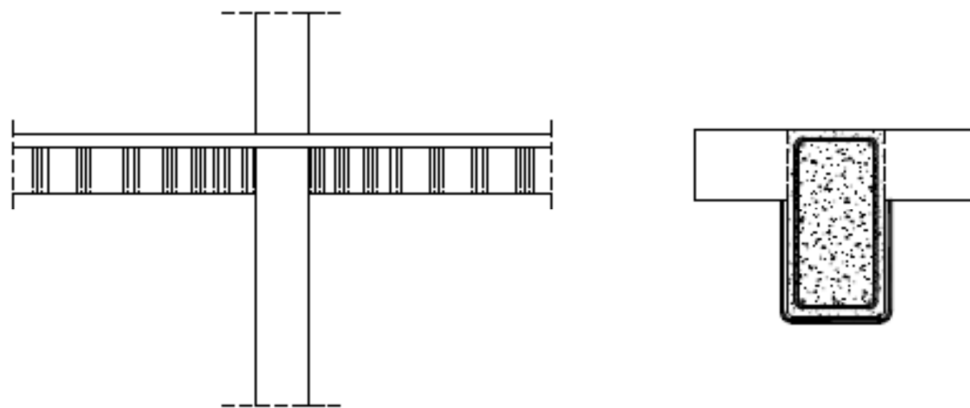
Reforzamiento a cortante discontinuo de una viga de hormigón armado interna con materiales compuestos CFRP o SRP, sin anclaje.
